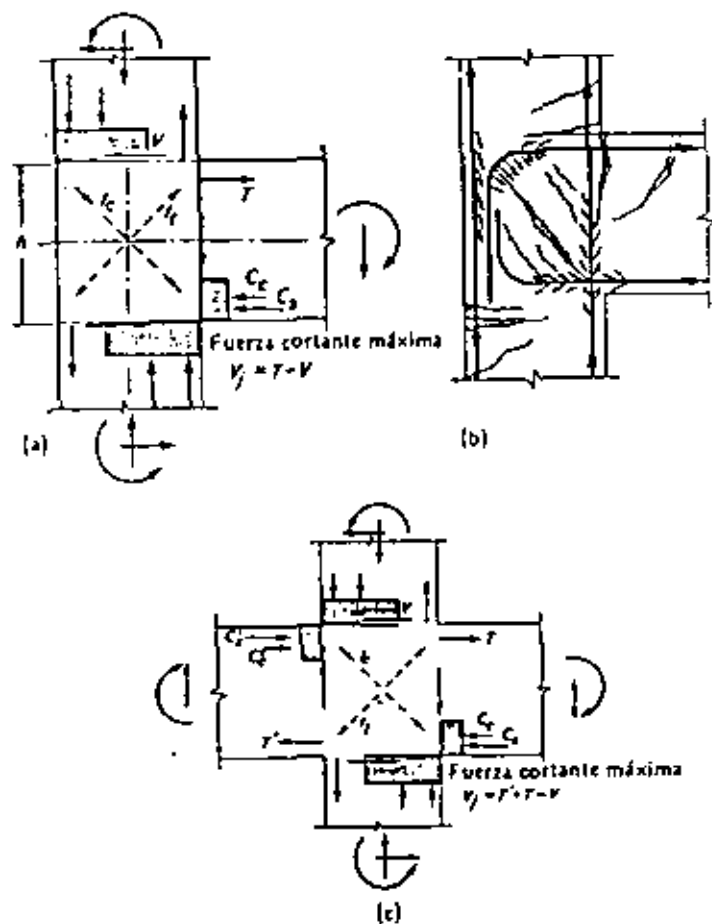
Juntas viga-columna del marco con carga sísmica. a) Acciones y resultantes de los esfuerzos en la junta exterior viga-columna; b) configuración del agrietamiento y fuerzas de adherencia en la junta exterior viga-columna; c) acciones y resultantes de los esfuerzos en una junta interior viga-columna.
